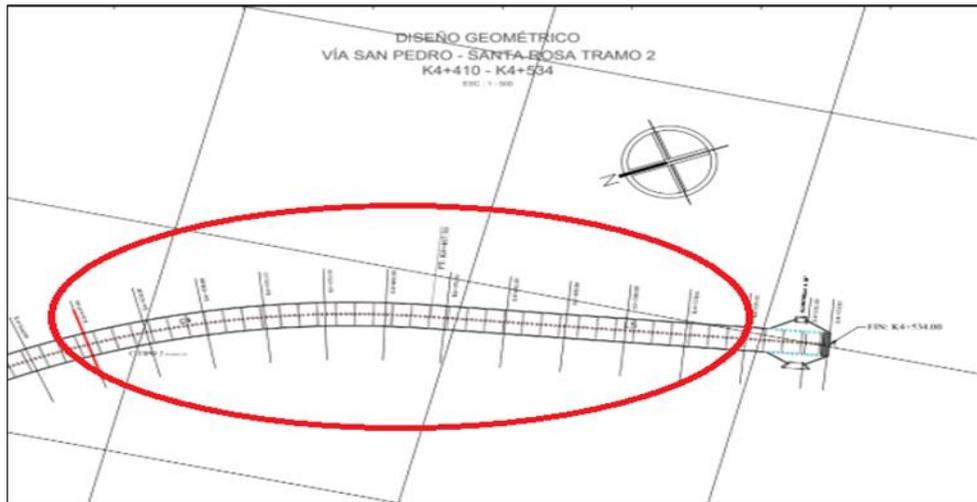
Ubicación de zonas críticas de erosión Frente de obra san pedro- santa rosa tramo 2- SAN PEDRO
